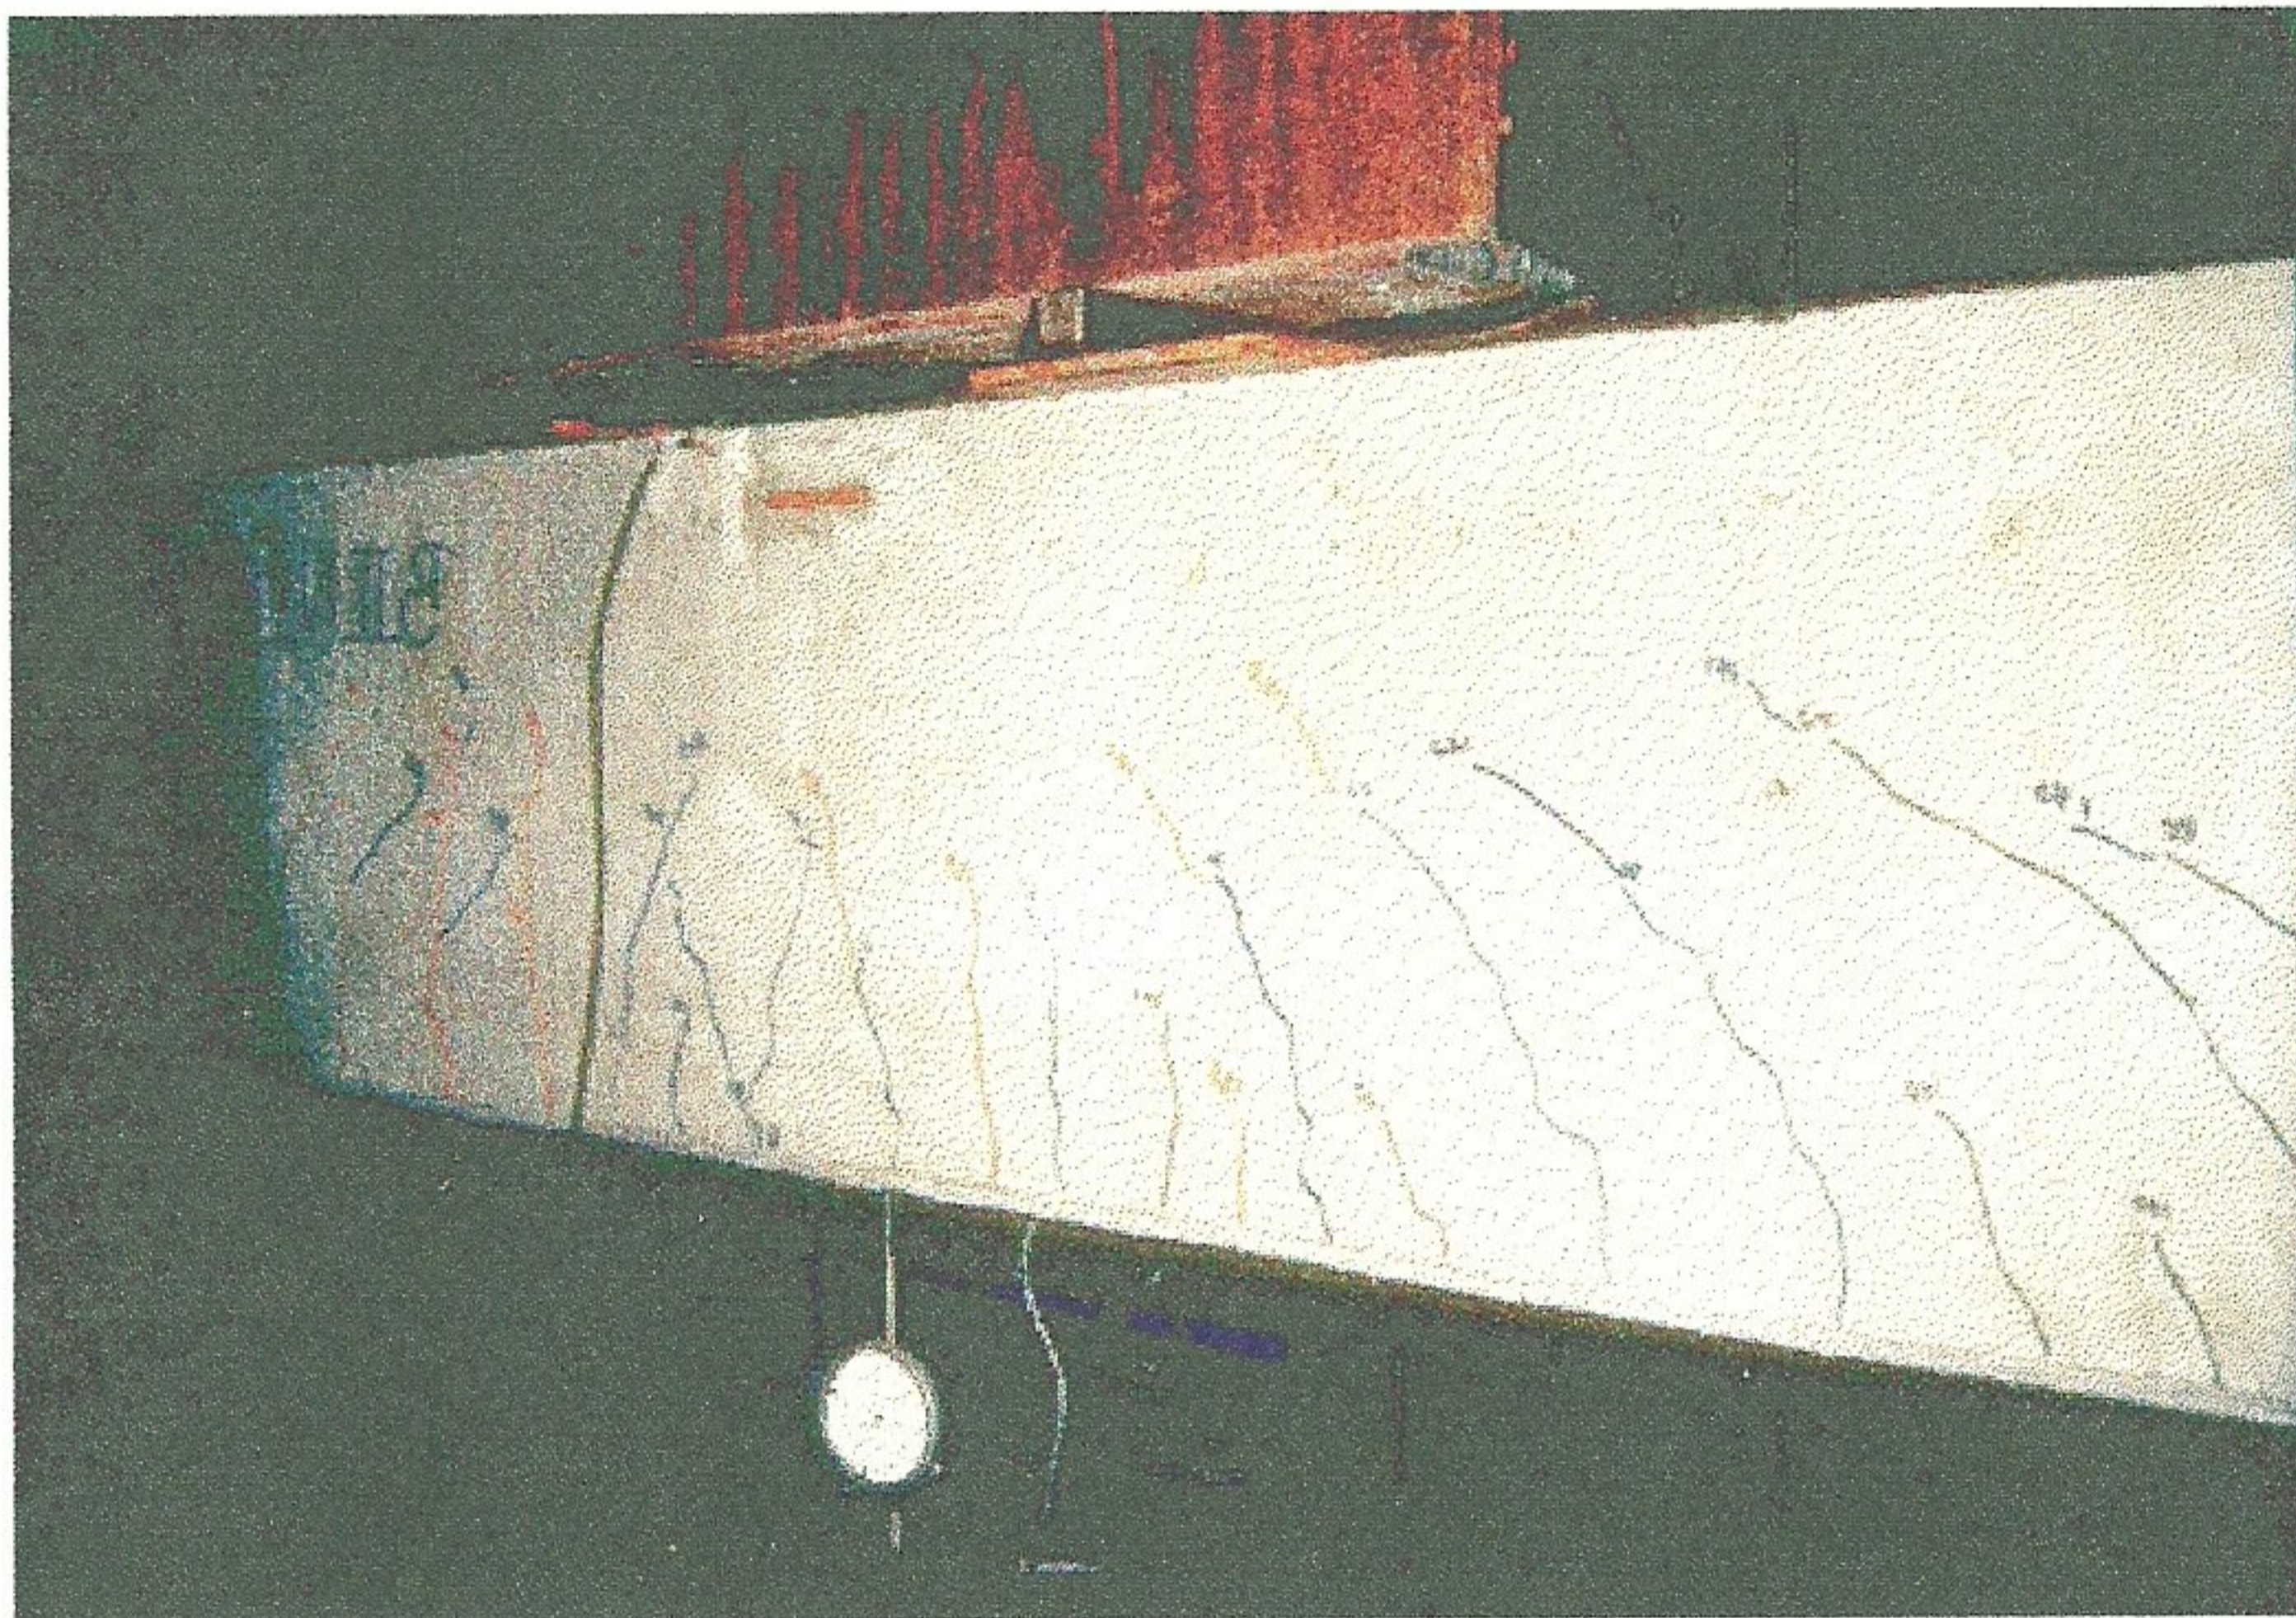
Fissuração típica em viga subarmada solicitada à flexão. [23]
